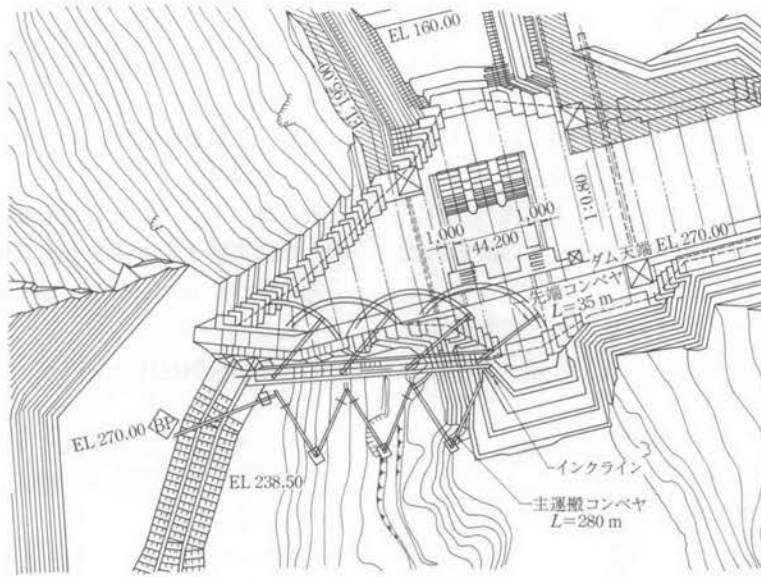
(1) コンクリート運搬ベルトコンベヤの概要図;ベルトコンベヤ・システム平面図
